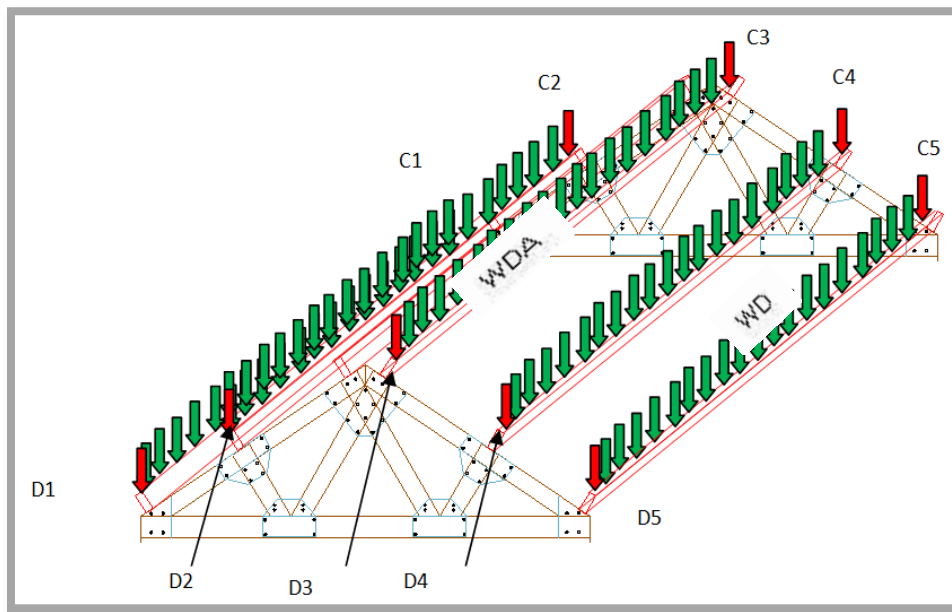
Distribución de las cargas WDA y WD, en las viguetas, en el tramo C-D.
